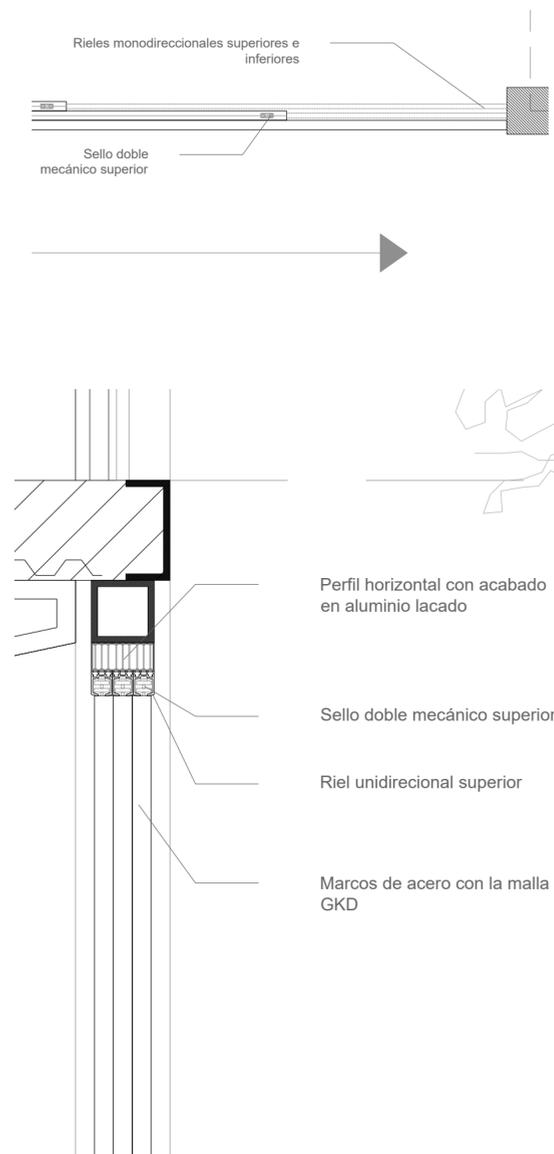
Planta y corte de la reja oriente. Fuente: Elaboración propia
